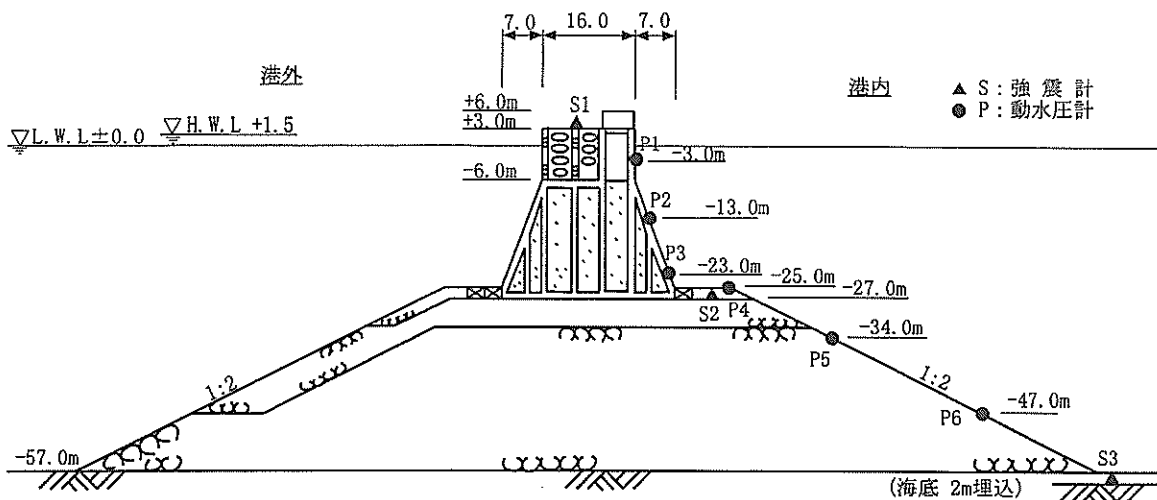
釜石湾口防波堤標準断面図 (計器設置図)
